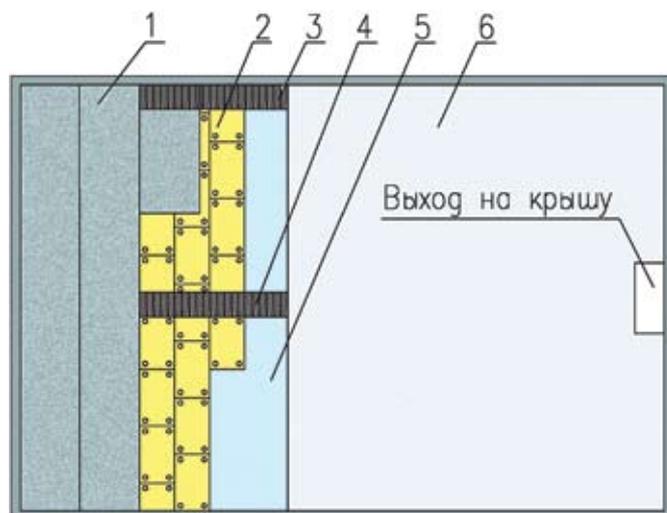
Схема монтажа утеплителя: 1 – кровельная мембрана; 2 – теплоизоляционный слой; 3 – инвентарные мостки для движения рабочих; 4 – изменение направления движения рабочих; 5 – пароизоляция; 6 – бетонное покрытие
